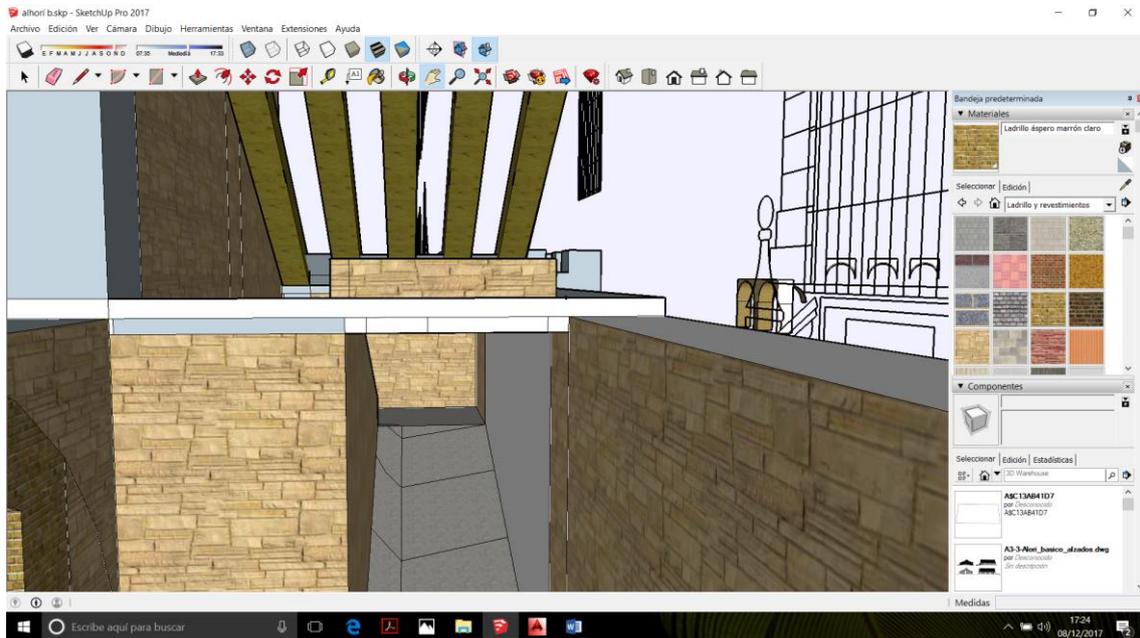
Diseño de las rampas de acceso a la planta superior
